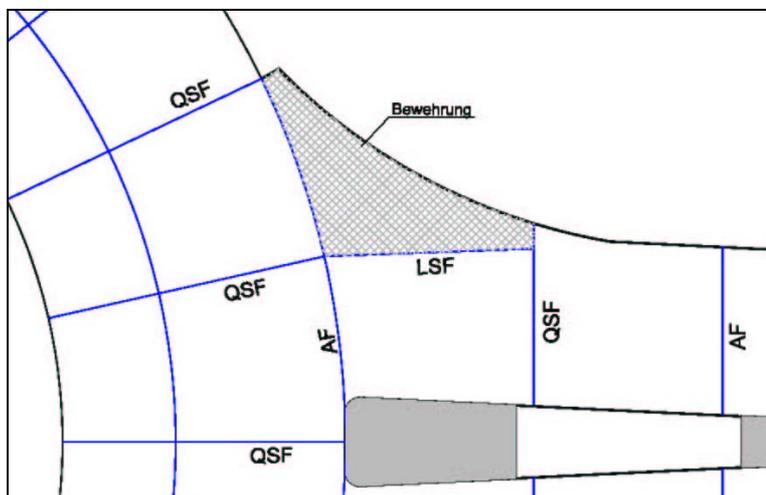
Bewehrung in spitz geformten Betonplatten
